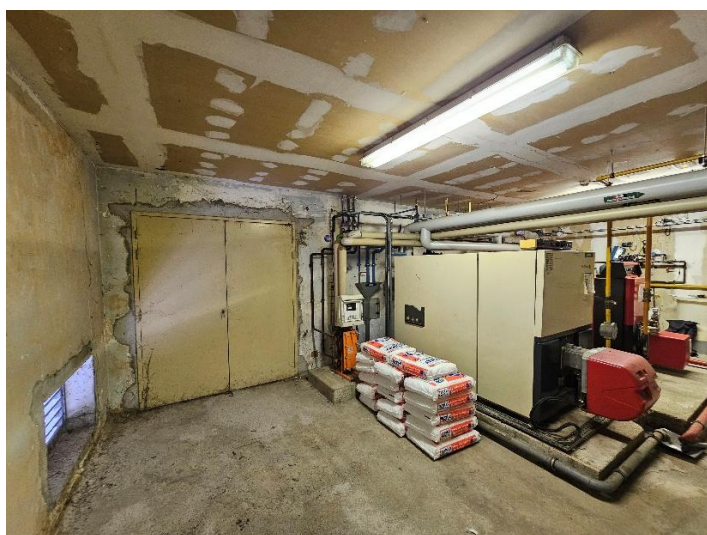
Chaudières à déposer et double porte existante donnant sur l'extérieur – bâtiment 308
